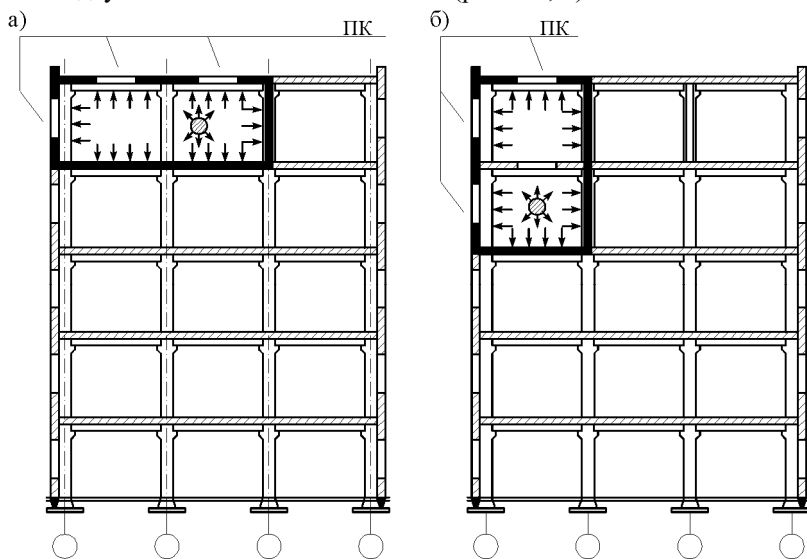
Варианты расположения взрывоопасных помещений в многоэтажных зданиях
